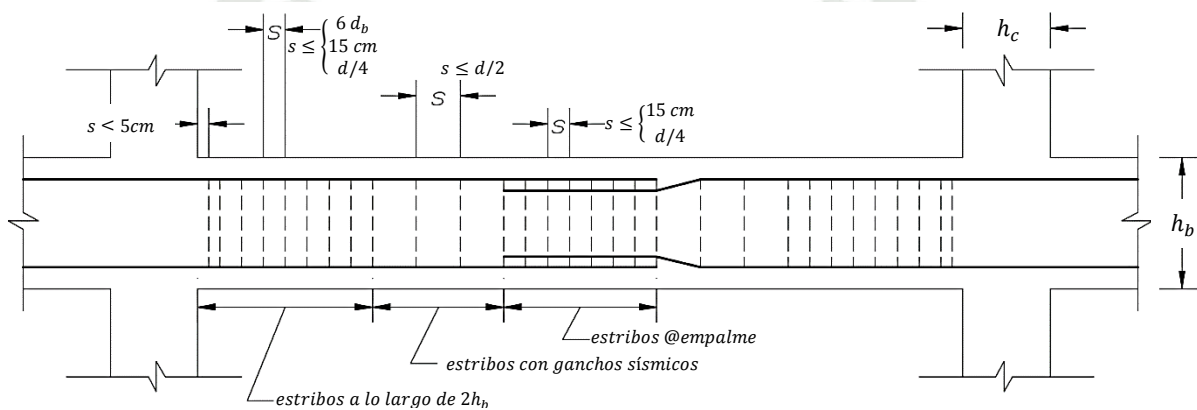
Espaciamiento de Estribos en Vigas Especiales
